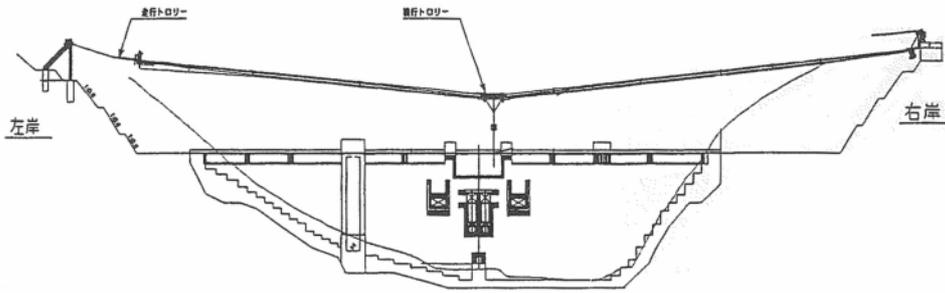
3 - 10 軌索式ケーブルクレーン配置図 (灰塚ダム)
